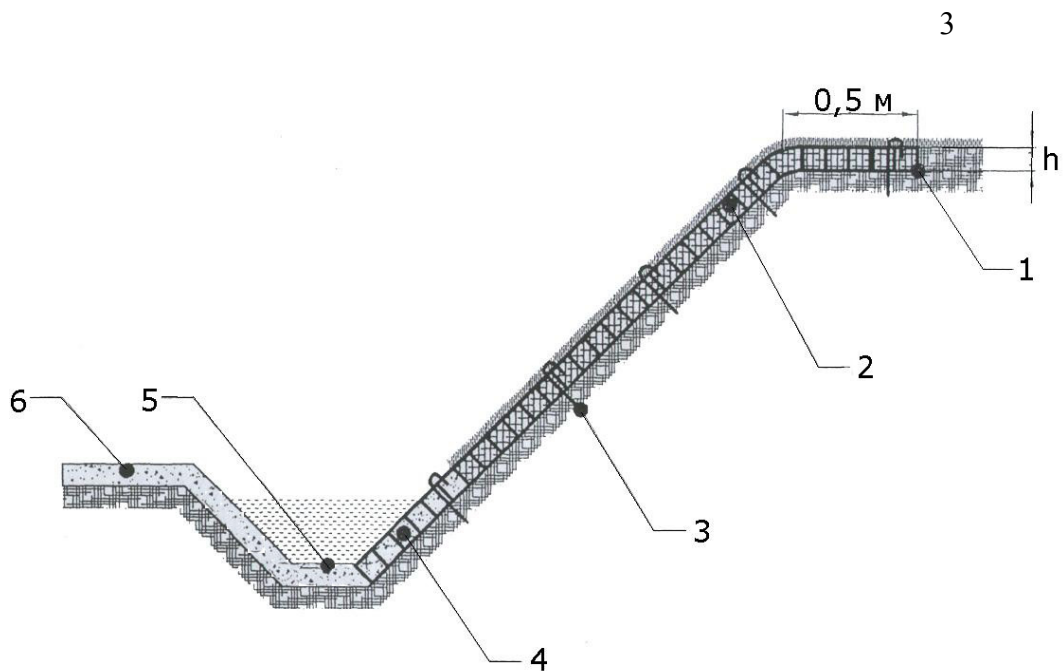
Конструкция укрепления откоса. 1- Армосот; 2 – растительный грунт; 3 – монтажные и несущие нагели; 4 – бетон или щебень; 5 – водосточный лоток; 6 – дорога.
